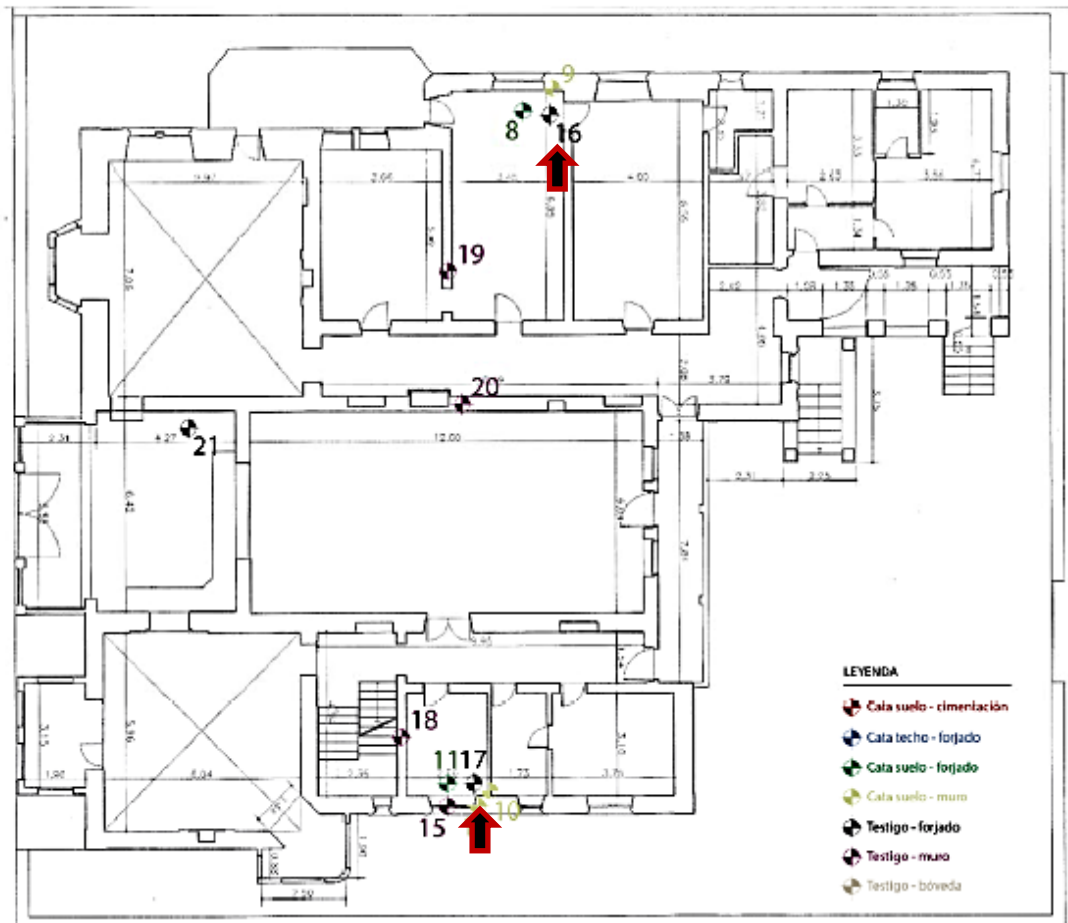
Ubicación extracción de testigos Planta Baja. Villa el castillito. Sanlúcar de Barrameda. (Fuente Songea)
